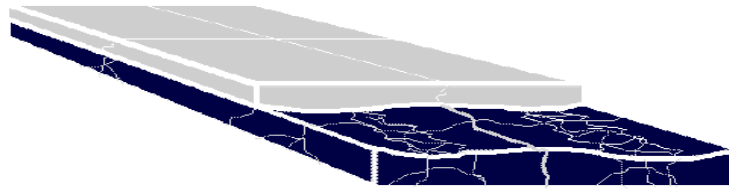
Construção de pavimento rígido sobre pavimento asfáltico degradado (“whitetopping”)
